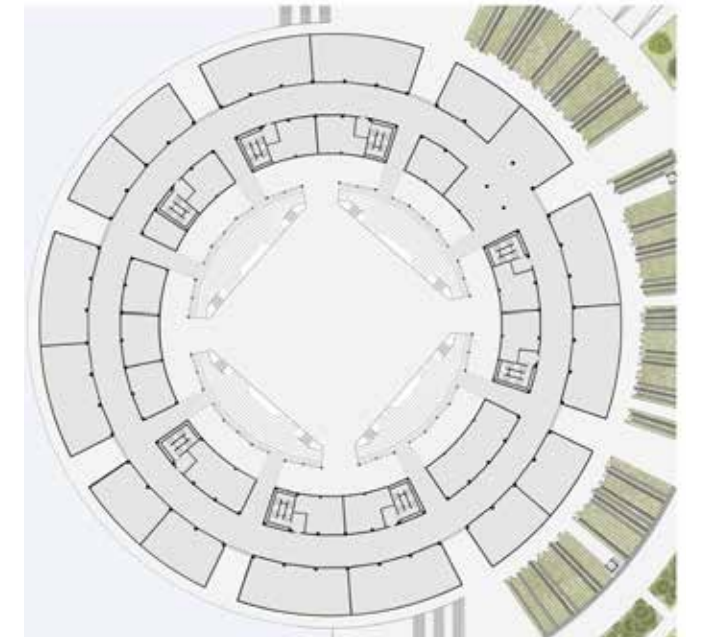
Pianta a quota +10 m e +14 m del Padiglione S
